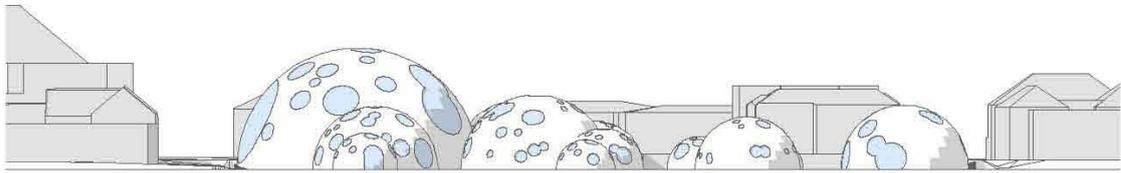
Neubauten Blickrichtung Westen, Maßstab 1:1000
